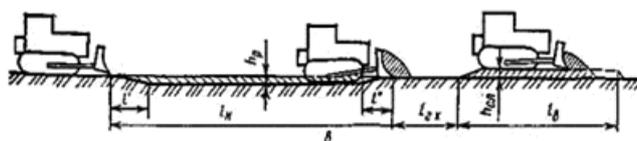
Схема работы бульдозера - набор, перемещение и отсыпка грунта
